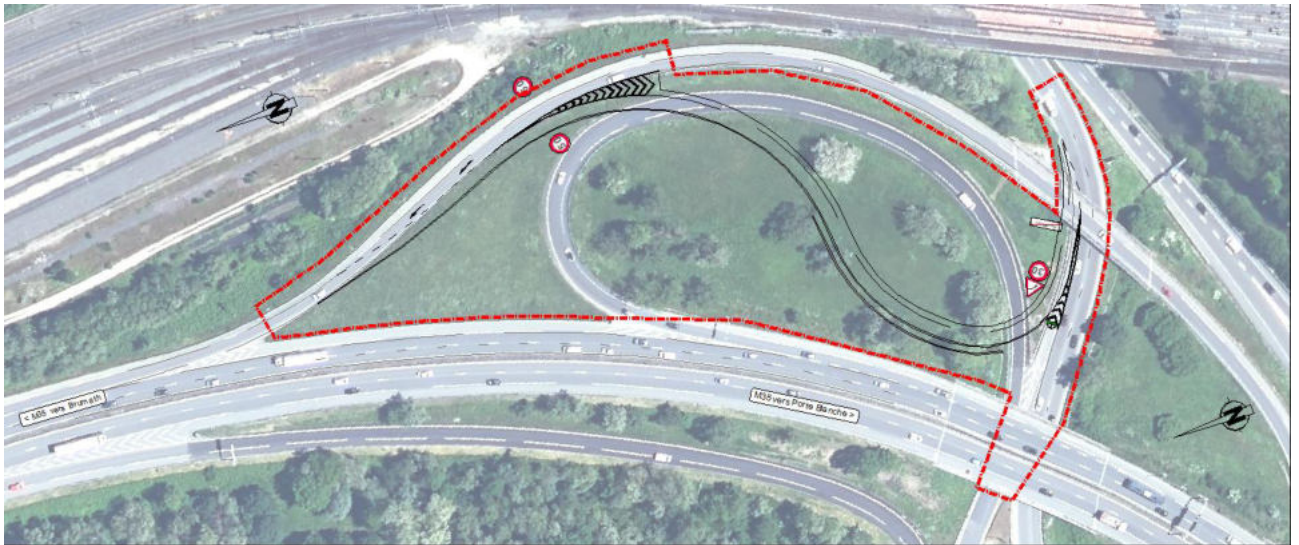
PLAN D'AMÉNAGEMENT - BRETELLE M2350-M35
